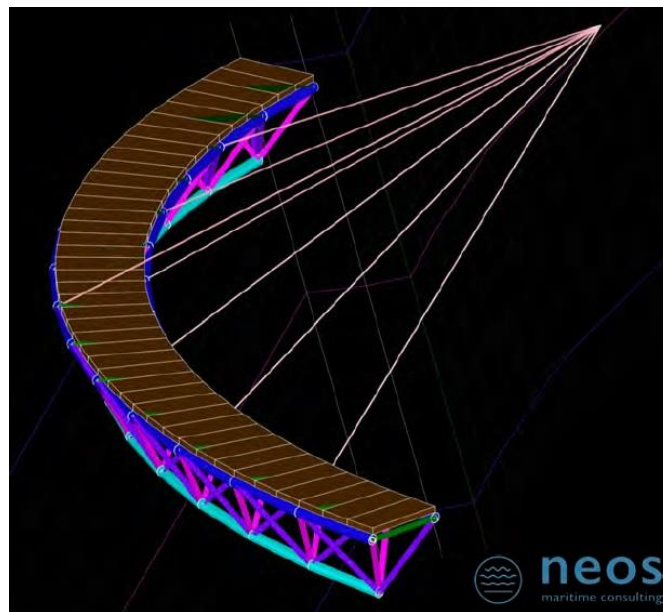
Modelo de elementos finitos de la estructura. (Estructuras de hormigón armado sostenibles e innovadoras, 2024)
